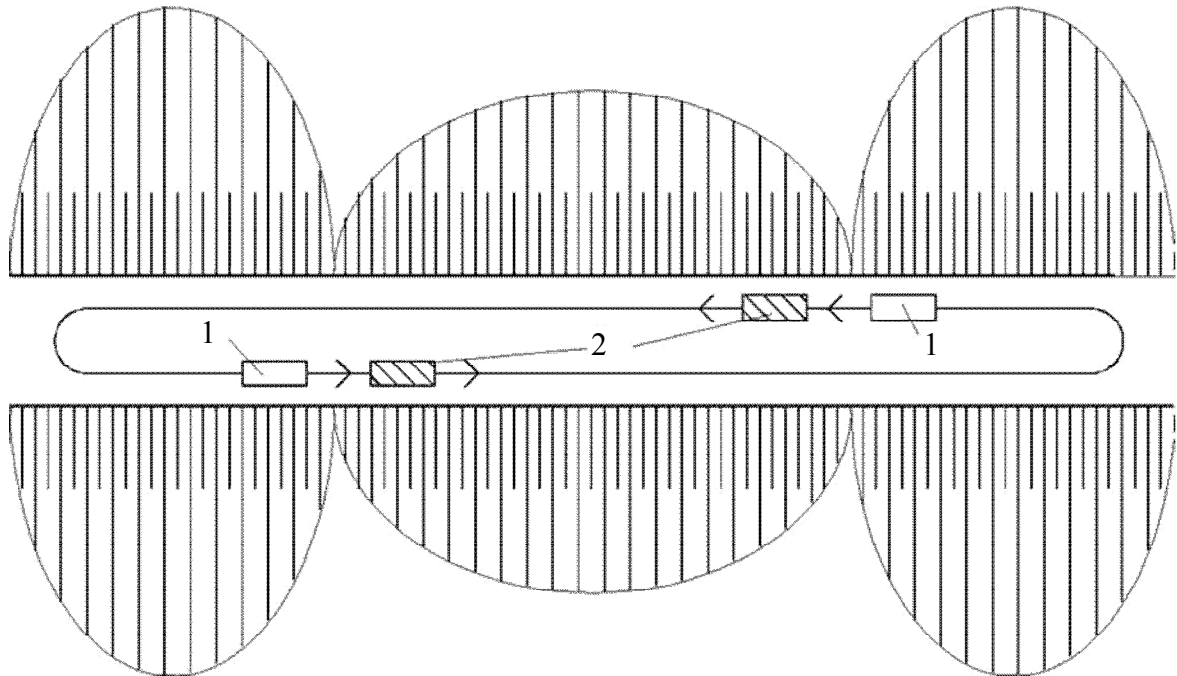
Еліптична схема руху скреперів із двох виїмок у насип: 1 – набирання ґрунту; 2 – розвантаження ґрунту
